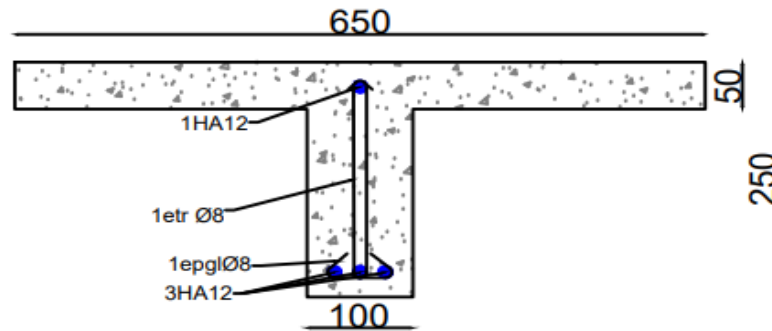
Le ferrailage des poutrelles sur l'appui de rive.
